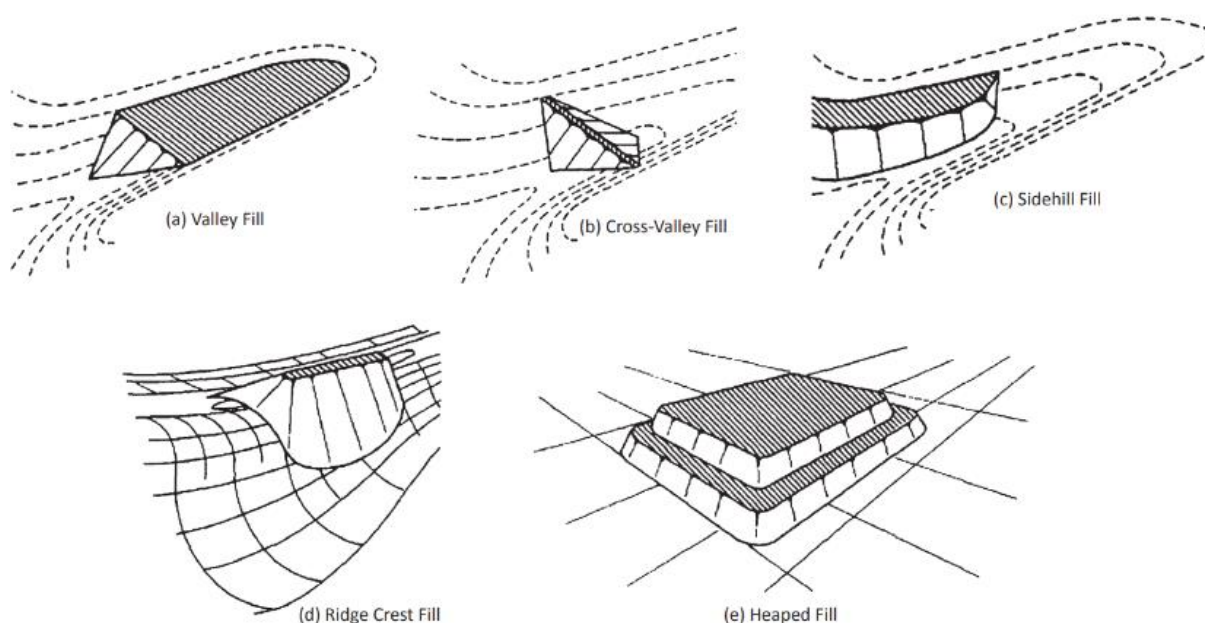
Tipos de estocagem em pilha (a - preenchimento de vale, b - preenchimento de vale cruzado, c - preenchimento lateral, d - preenchimento da crista do cume, e - preenchimento amontoado). (Fonte: Hawley e Cuning, 2017).
